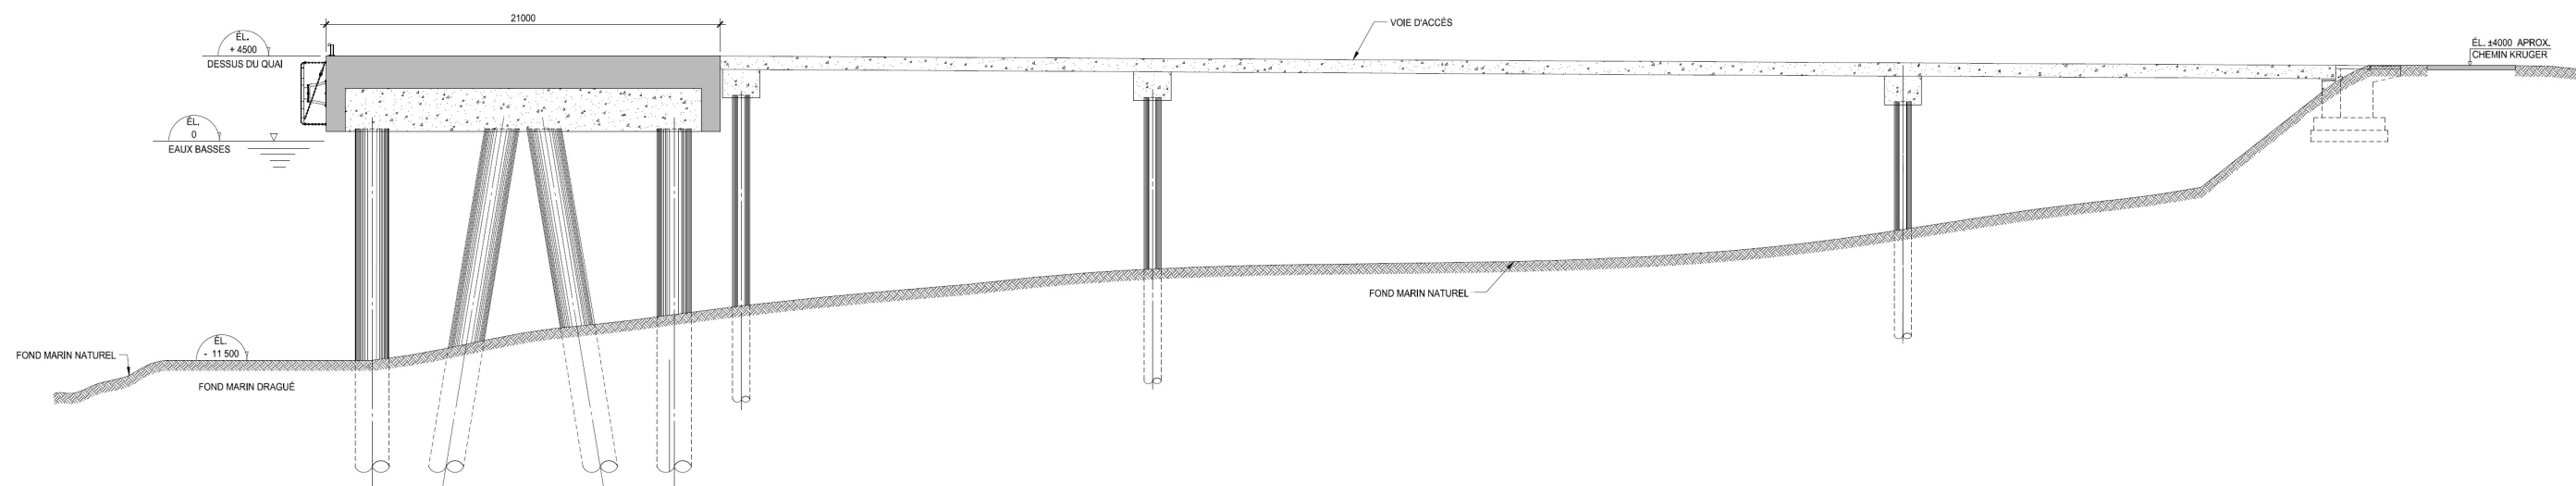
Coupe-type de la variante 3 - Dalle sur pieux avec pont sans entreposage
